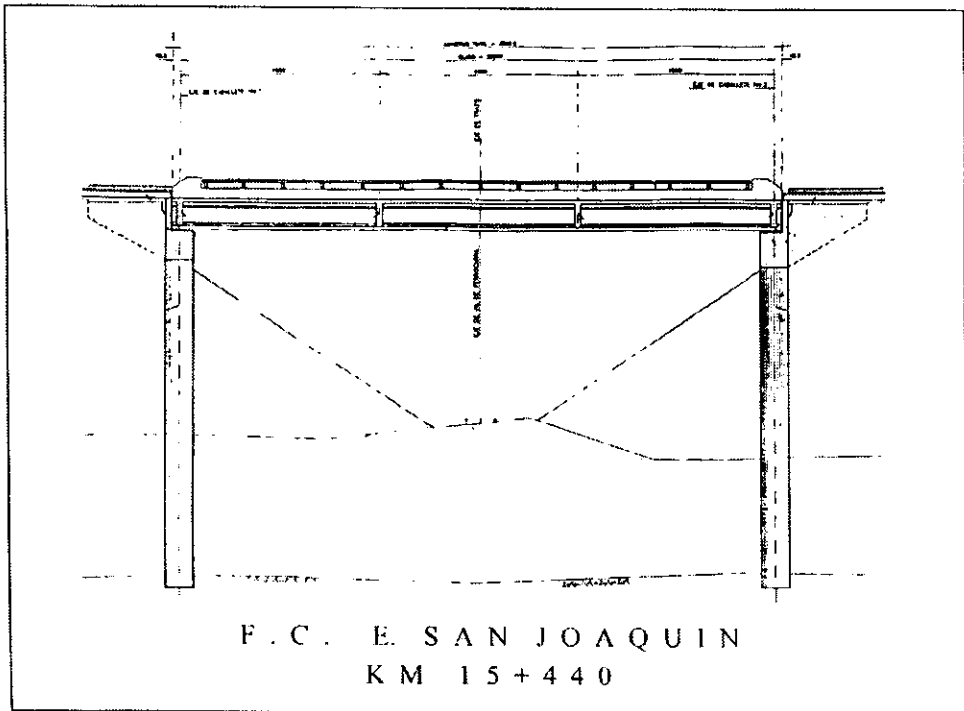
Plano en alzado del F.C.E. San Joaquín.
